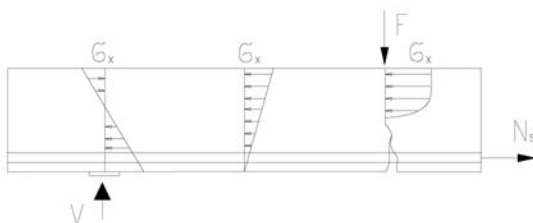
Характер розподілу нормальних напружень у прольоті зрізу залізобетонних балок без зчеплення повздовжньої арматури з бетоном.
